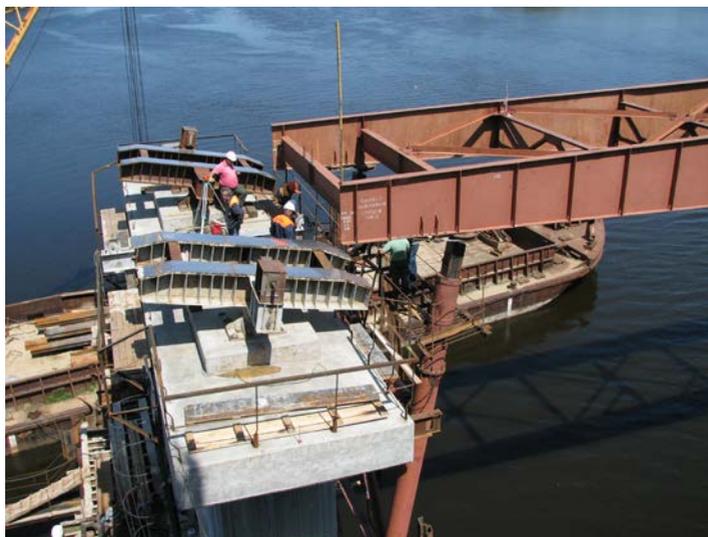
Третий этап надвигки. Аванбек на ППУ у опоры № 3
